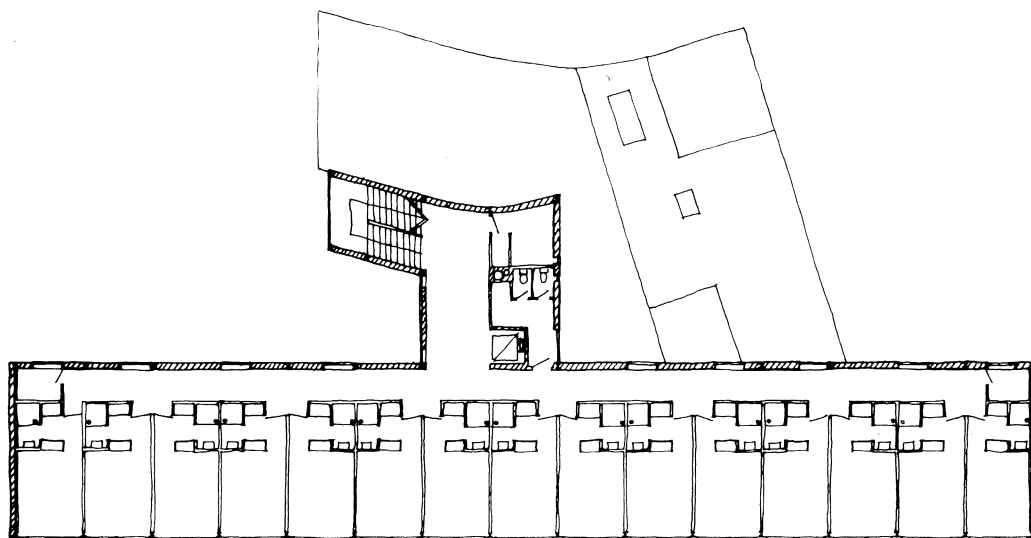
PABELLON SUIZO - PLANTA DORMITORIOS.
